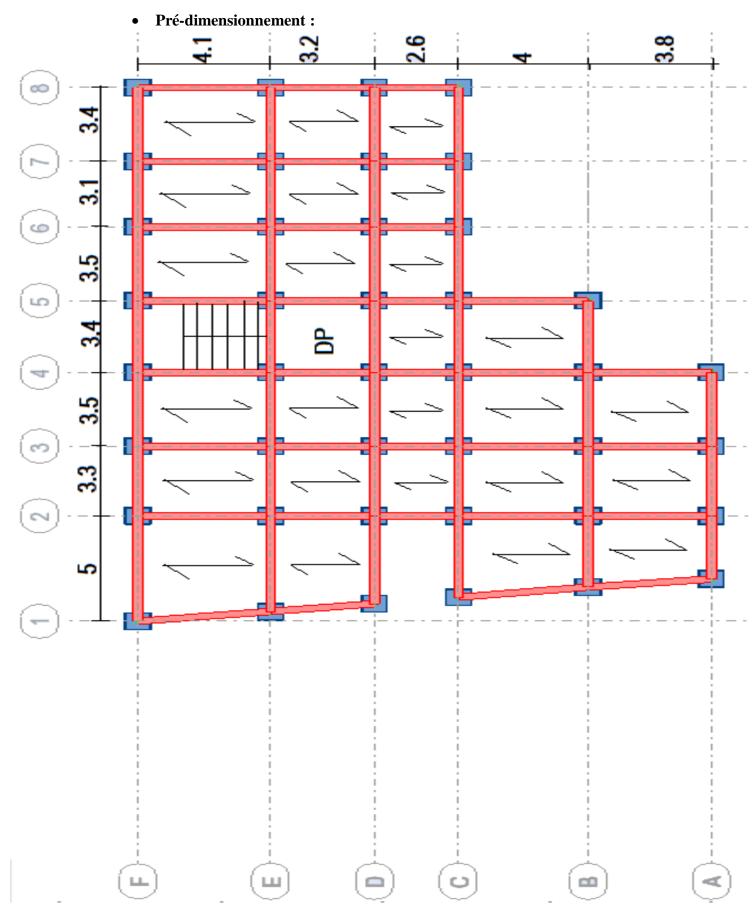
vue en plan du plancher et la disposition des poutrelles
